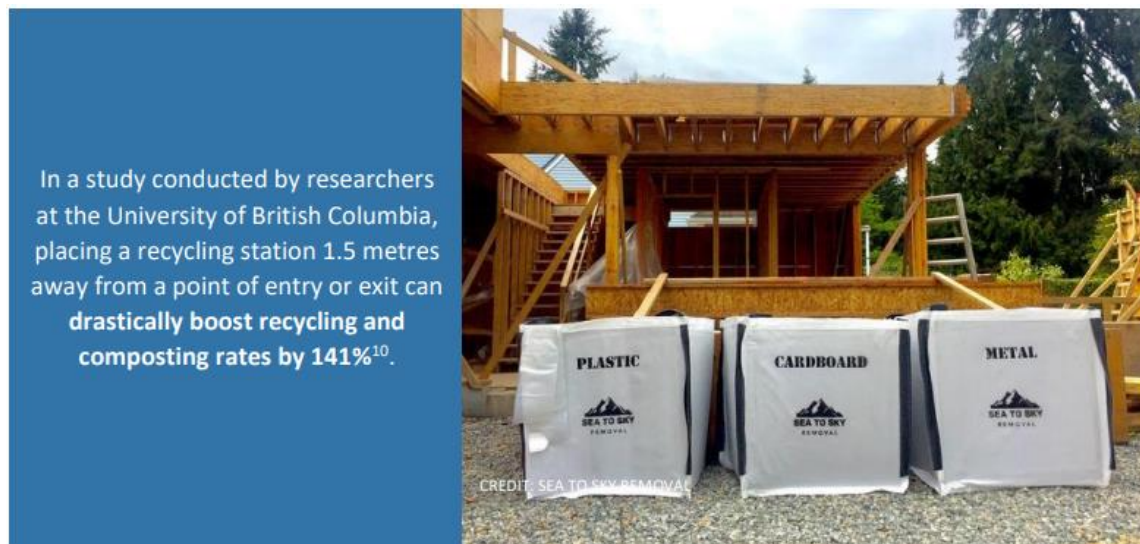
Station de recyclage au point de passage d'un chantier de construction (Synergy Foundation, 2022)
